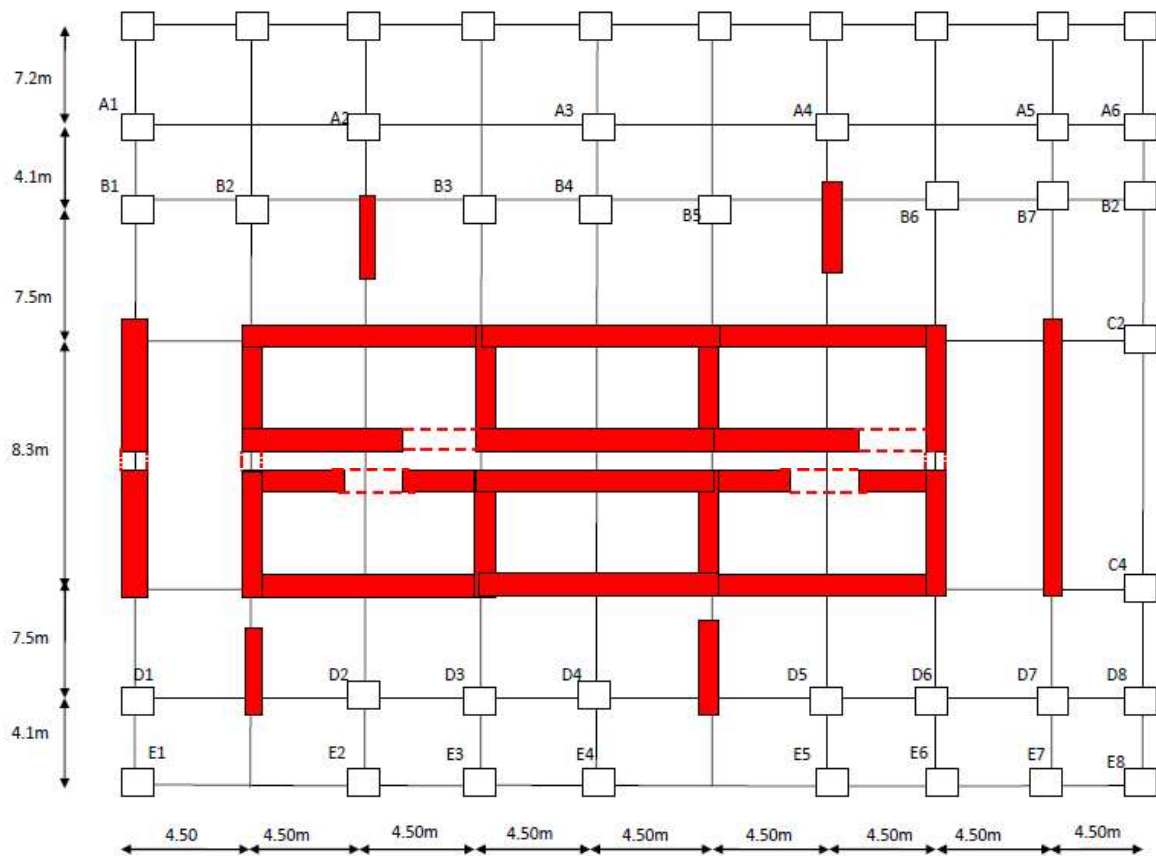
disposition des poteaux et des voiles au niveau podium.
